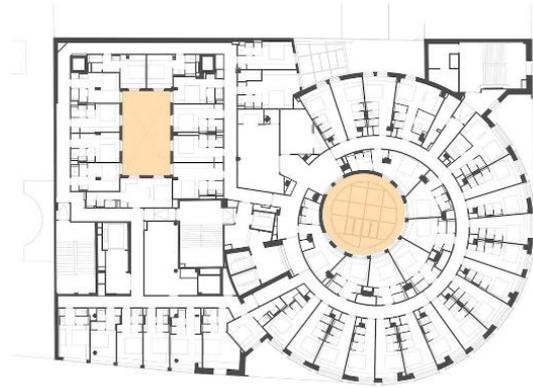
Grundriss Obergeschoss 2015,
